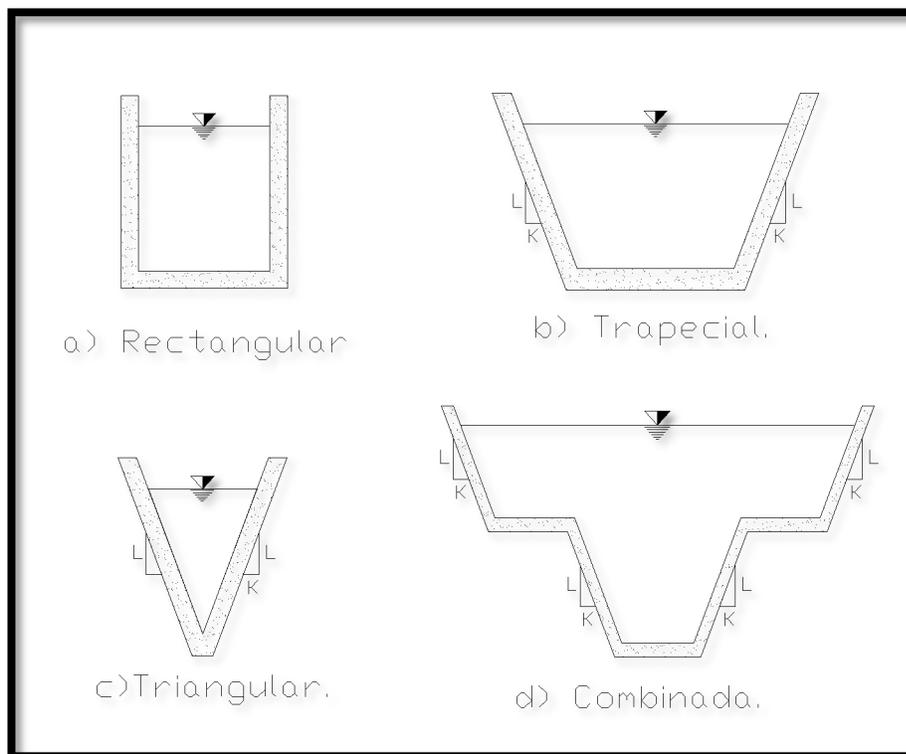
Tipos de canaletas o cunetas para descarga a cielo abierto.
